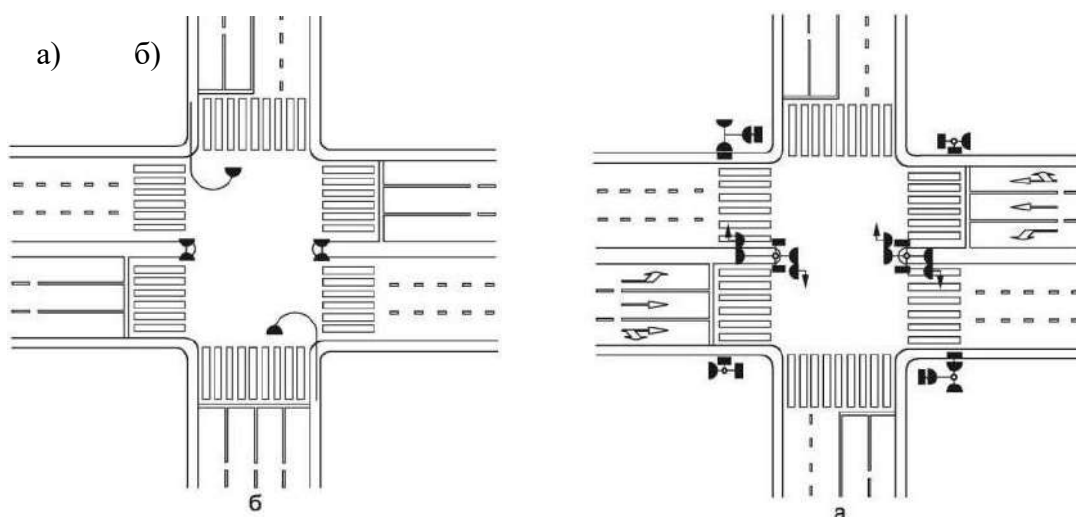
Примеры размещения светофоров: а - на перекрестке; б - на разделительной полосе и над проезжей частью
